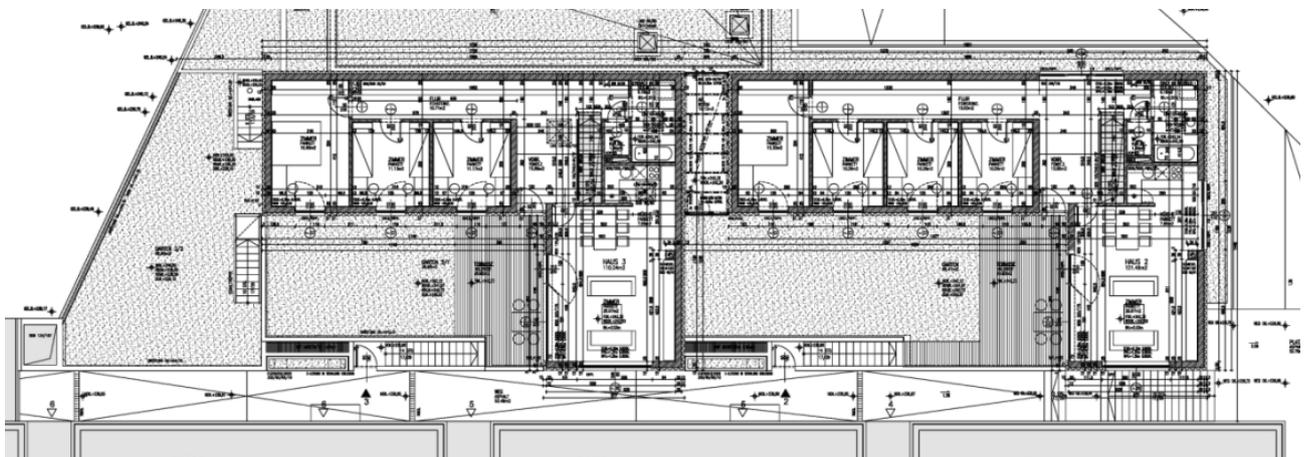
Grundriss Atriumhaus „Am Hundssteig“, Quelle: Archiv Architekt Linsberger
